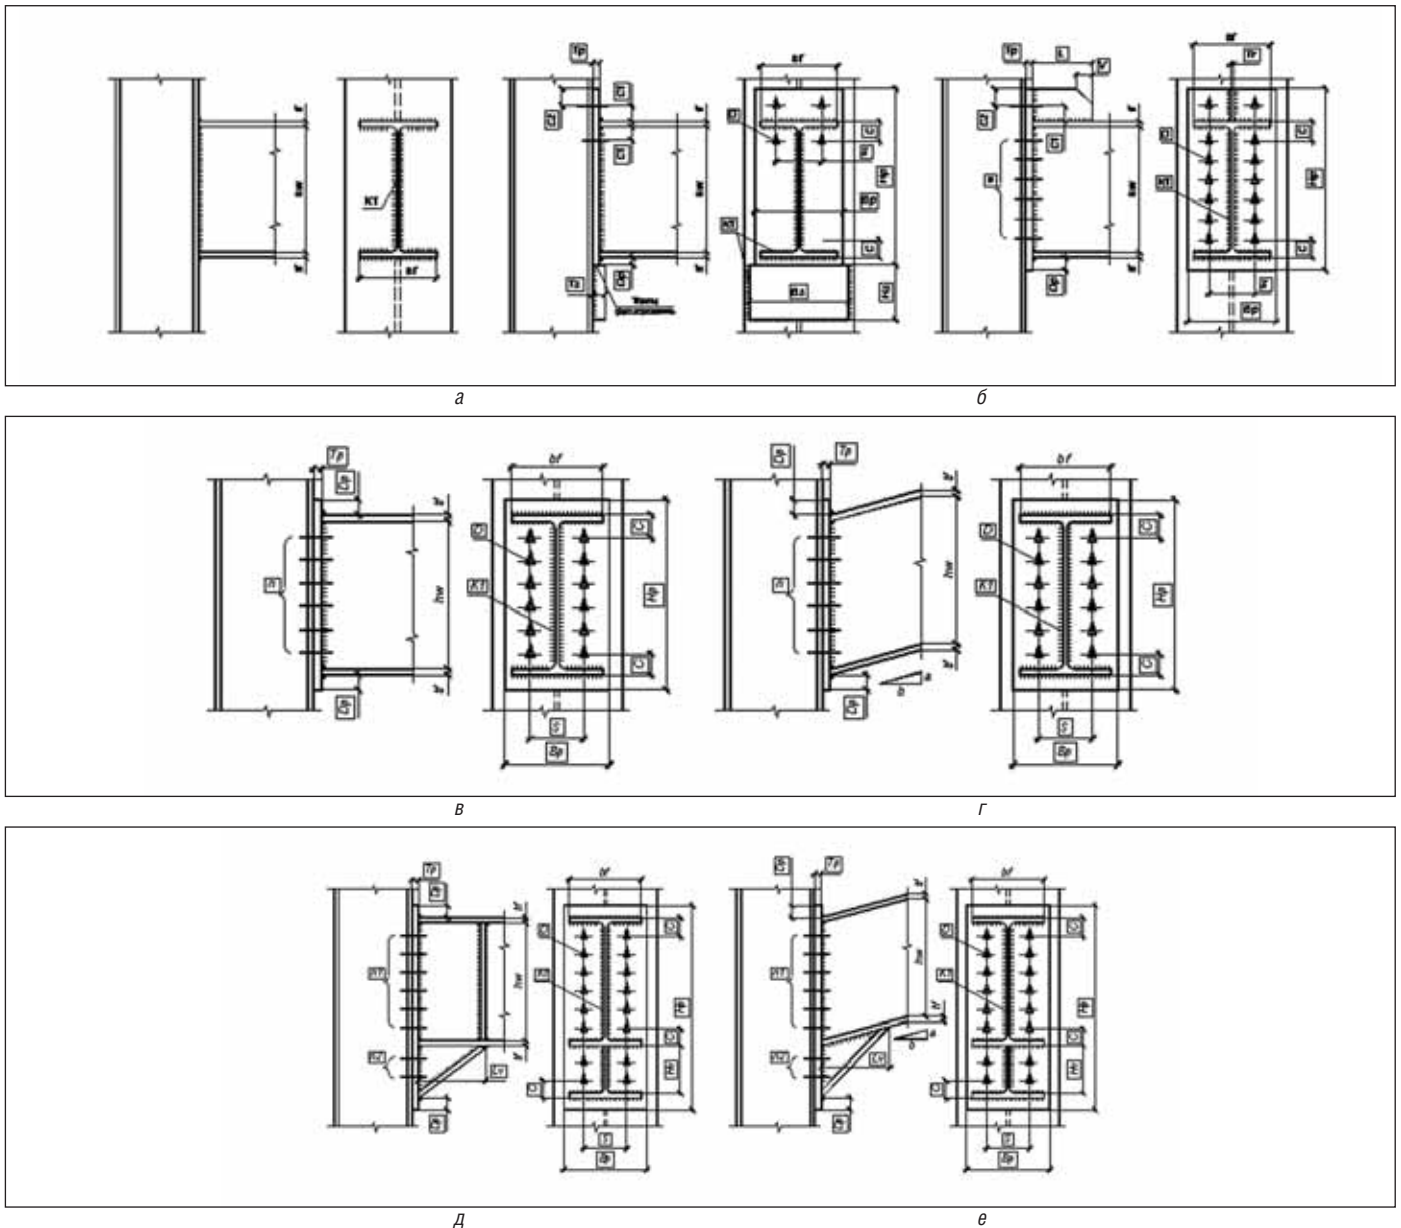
Типы конструктивных решений узлов жесткого сопряжения ригеля с колонной с использованием фланцевых соединений
